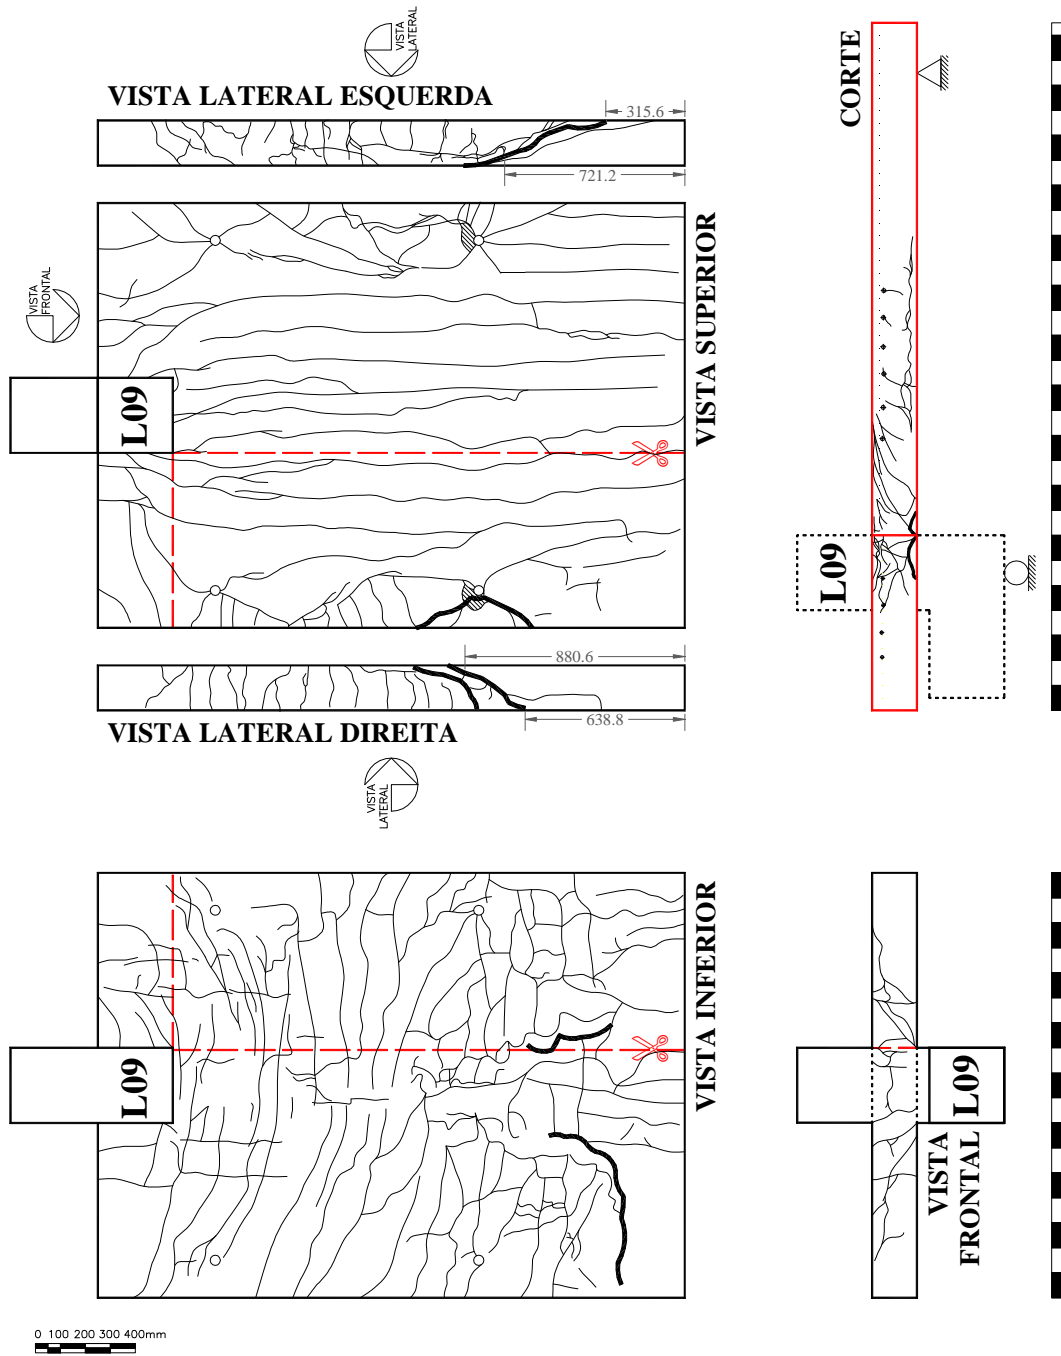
Padrão de fissuração da laje L09
